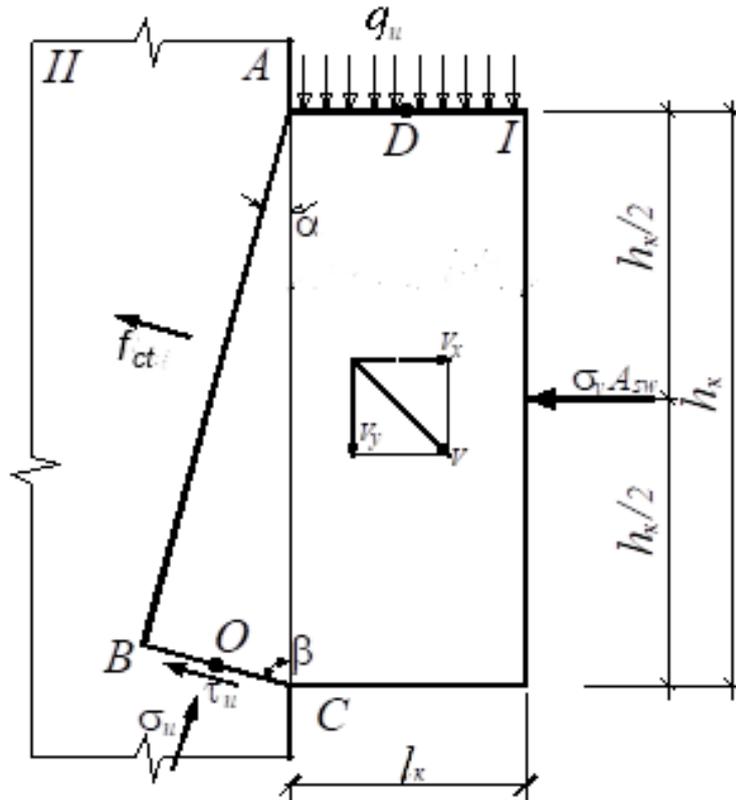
Кінематично можлива схема руйнування прямокутних залізобетонних шпонок шляхом зрізу при розташуванні арматури в один ярус посередині висоти шпонки
